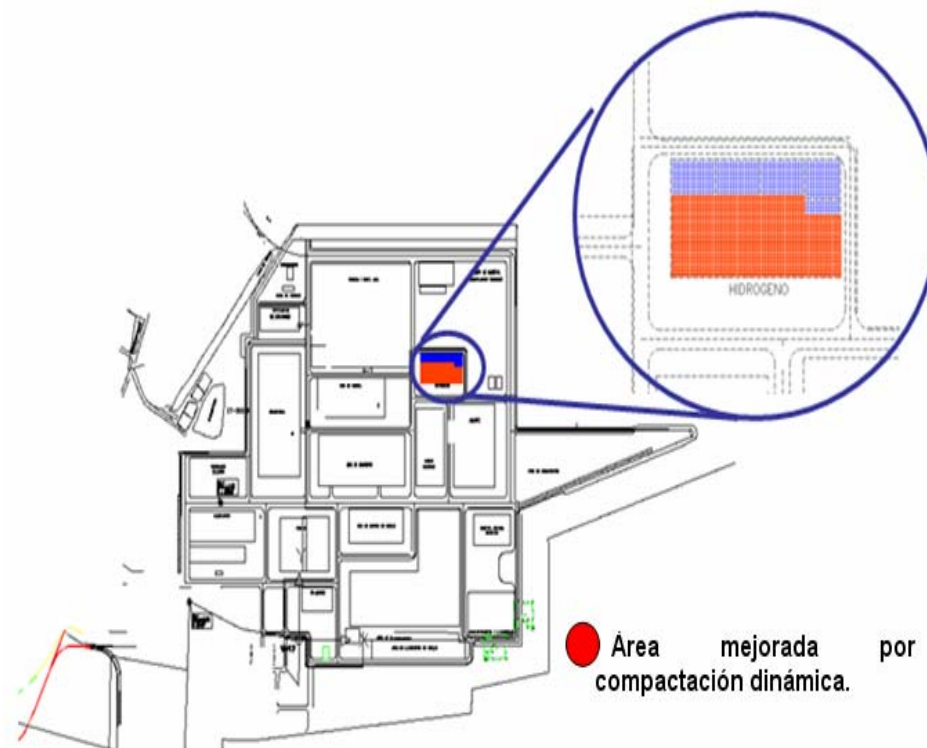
Registro del área terminada por el mejoramiento en planos.
